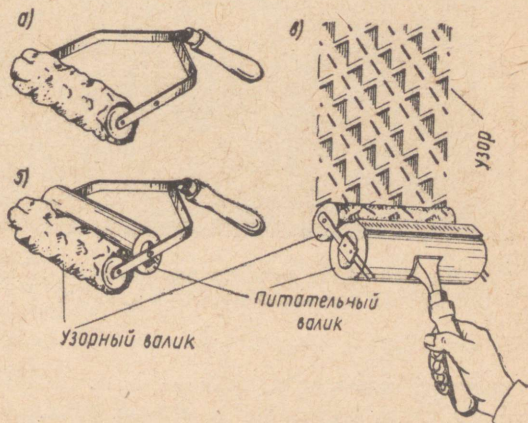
Отделка поверхности узорным валиком: а) узорный валик; б) узорный валик с питательным валиком; в) накатка узора на поверхность.
